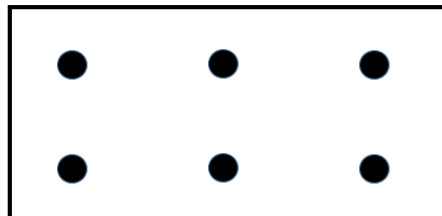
Système avec panneaux isolants GUTEX THERMOWALL L de dimensions 1250 × 590 mm
